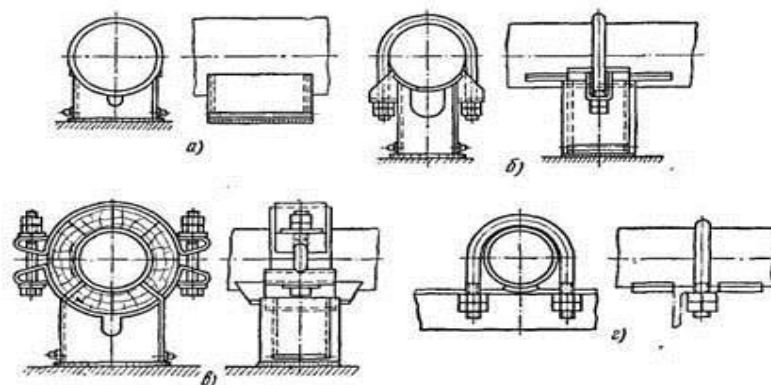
Конструкции неподвижных опор трубопроводов, где:
